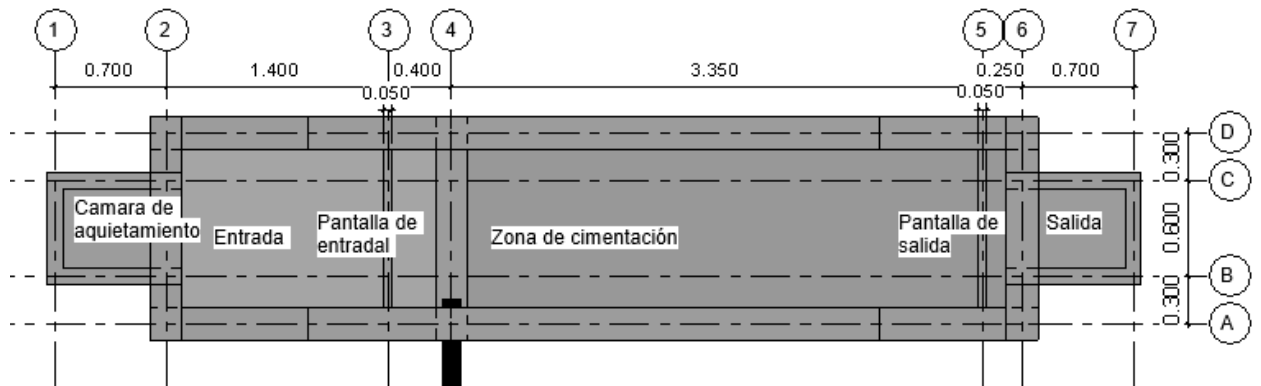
Vista en planta bocatoma sistema Alto del Rayo.
